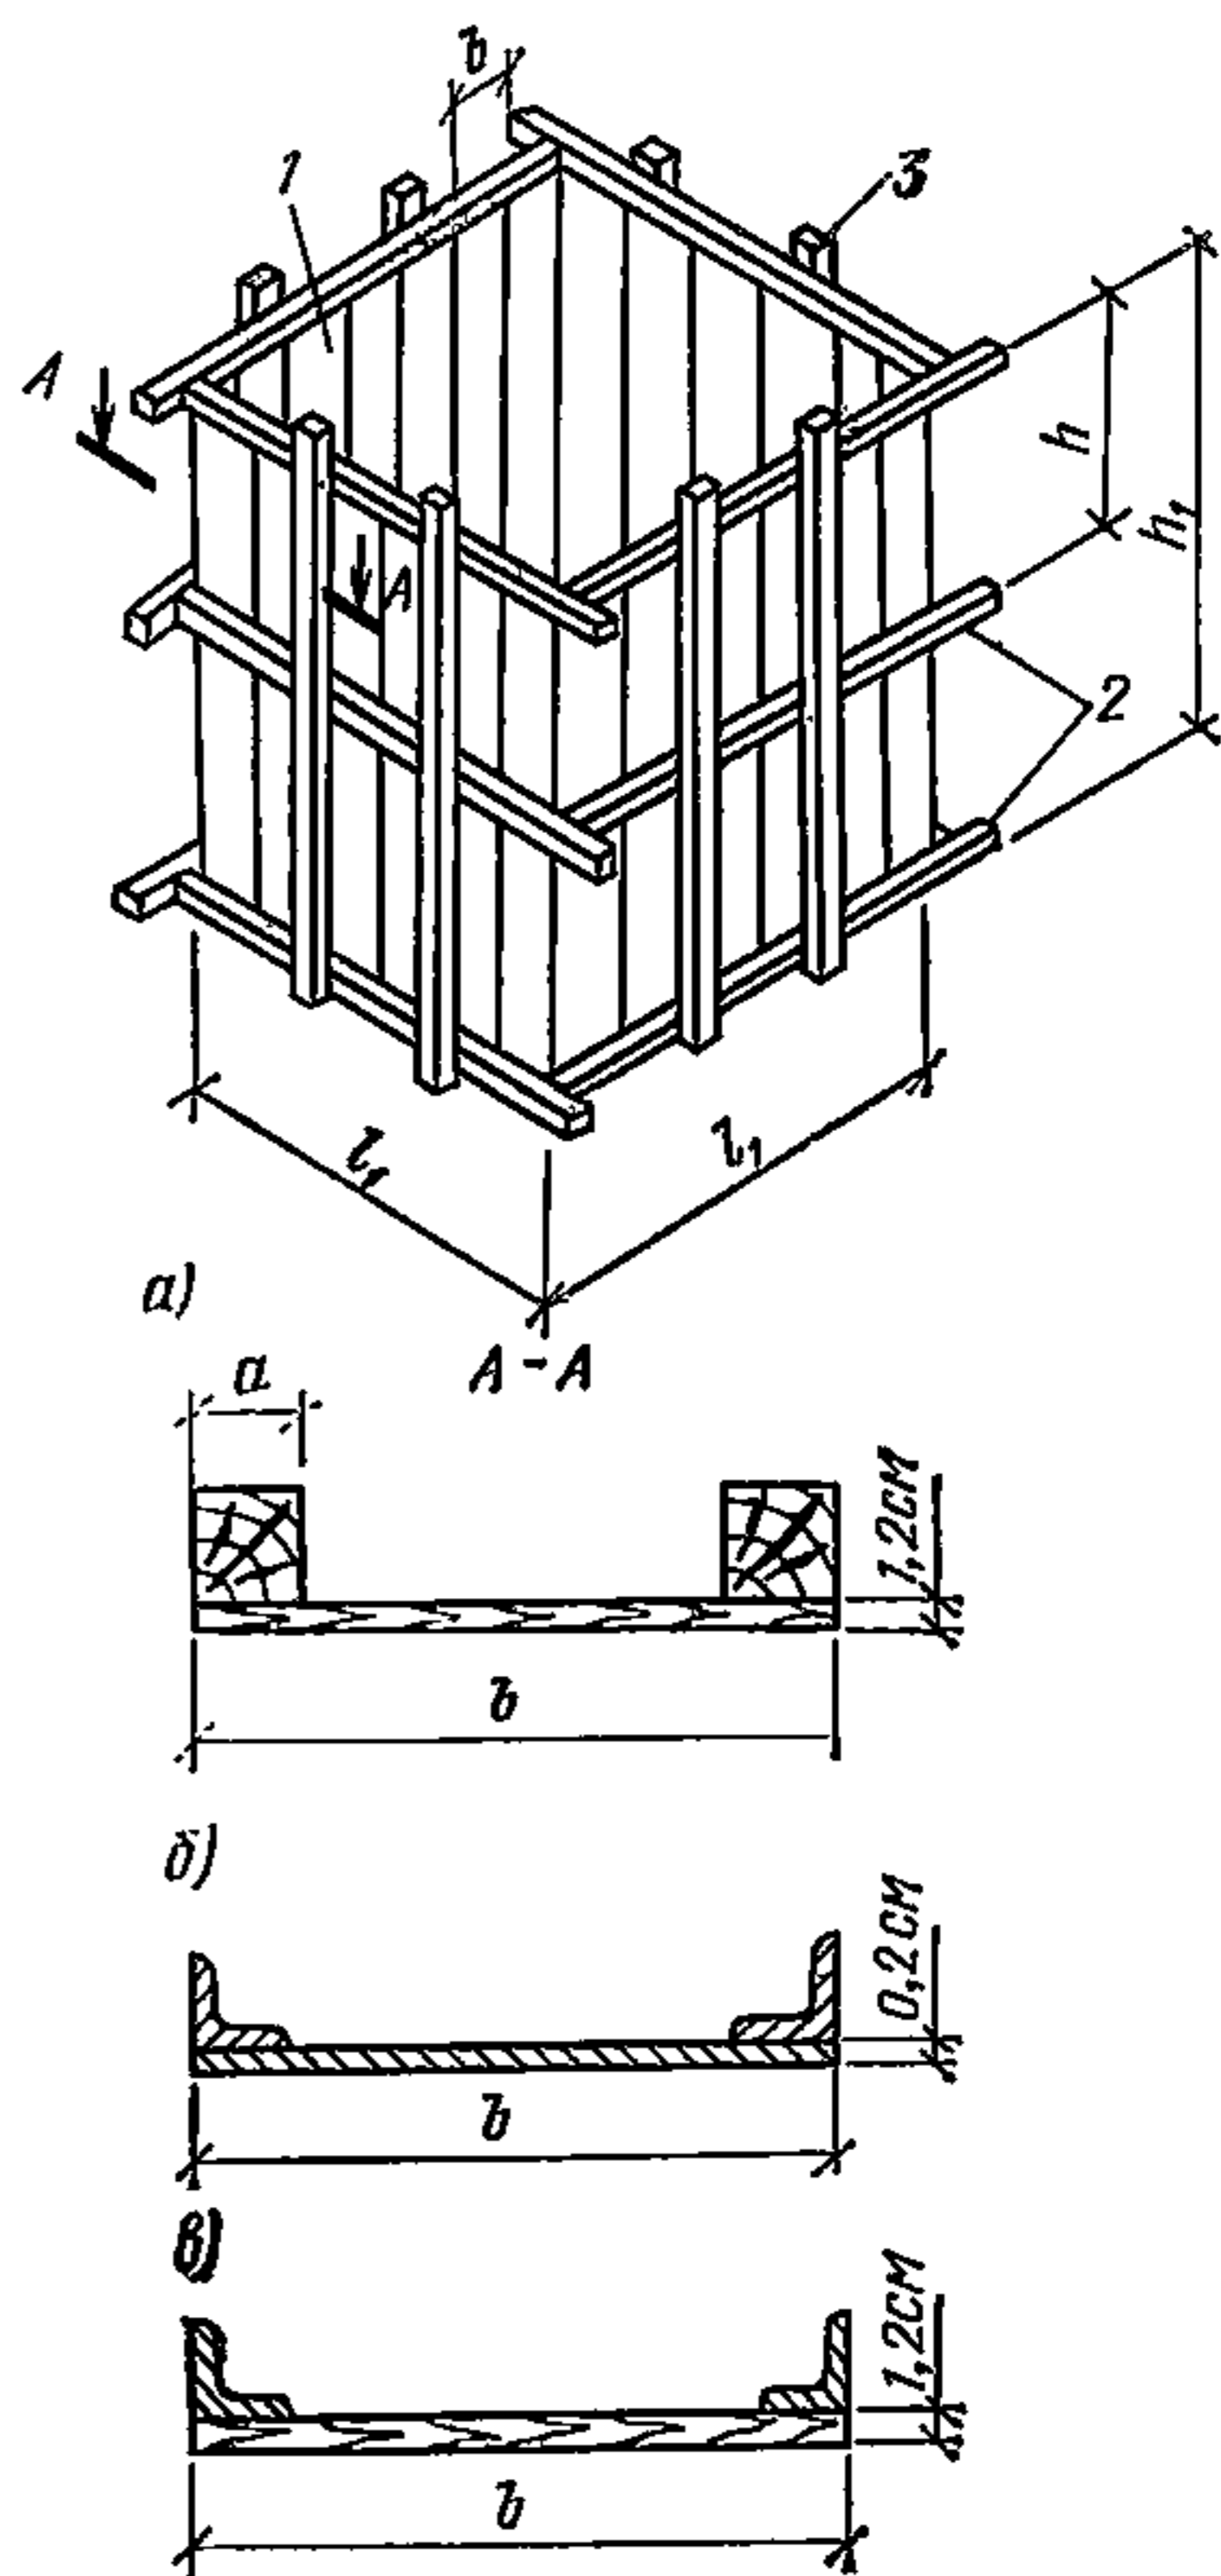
Опалубка конструкции в плане не более 3×3 м
